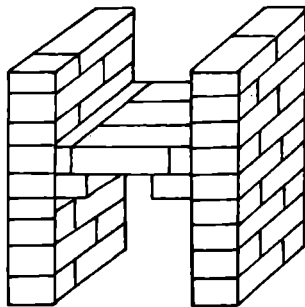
Перекрытие топливника путем выпуска кирпича из боковых стенок кладки
